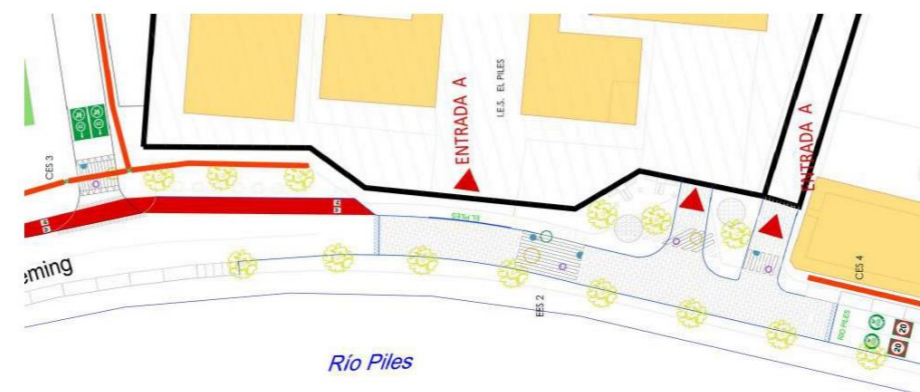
Plano detalle del EES de la Entrada A del CP Río Piles (y IES El Piles)
